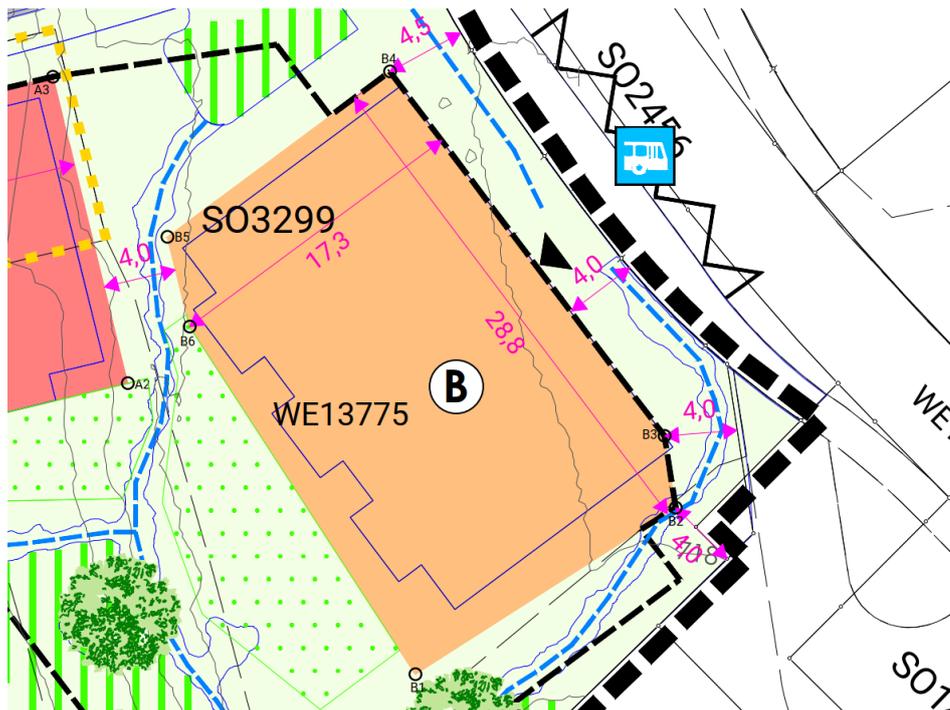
Ausschnitt Situationsplan Baubereich B mit Richtprojekt (blau) und um 4° abgedrehtem Richtprojekt (schwarz) (Darstellung R+K)
